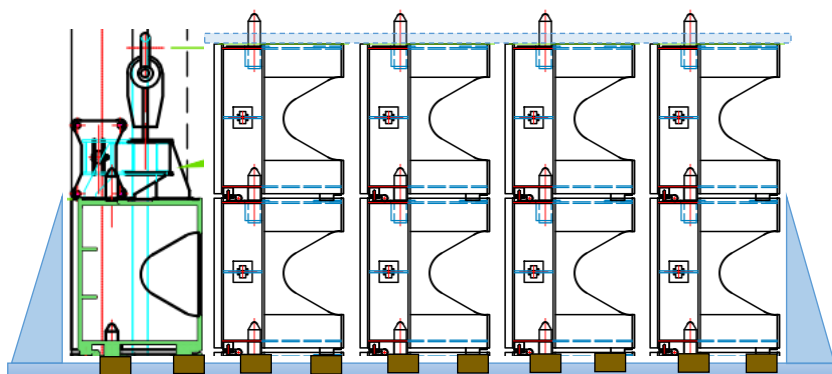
Principe d'empilement pour stockage des poutres de pertuis
